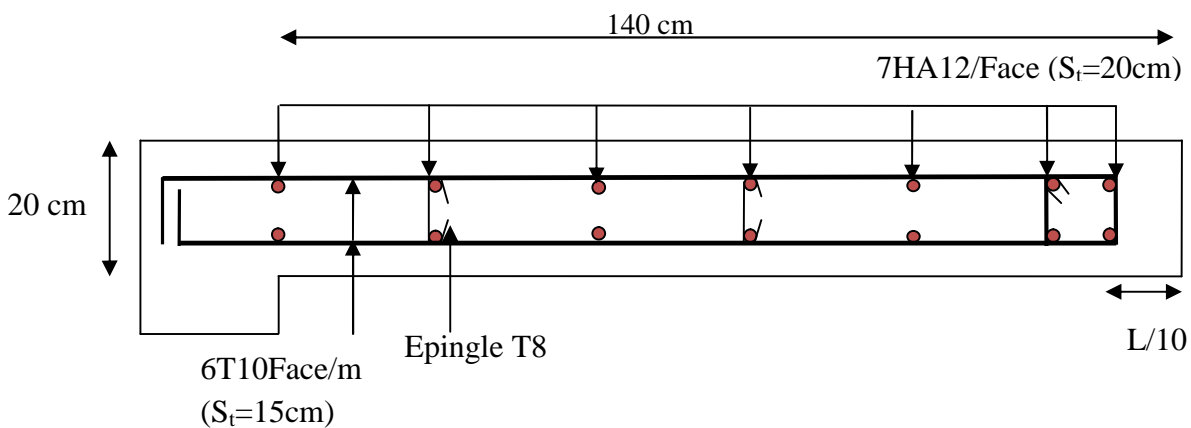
Schéma de ferrailage du voile Vy1 du 1^{er} entre sol
